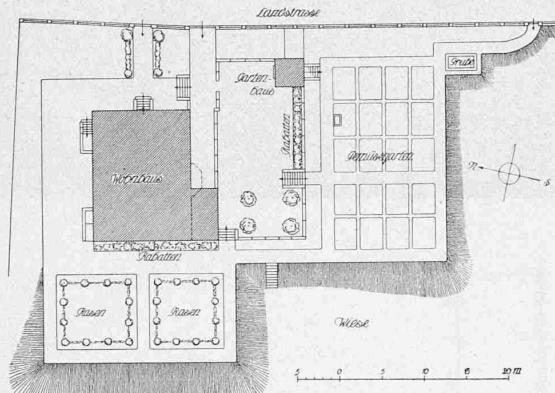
Haus «Blumenegg». — Lageplan 1 : 800.
